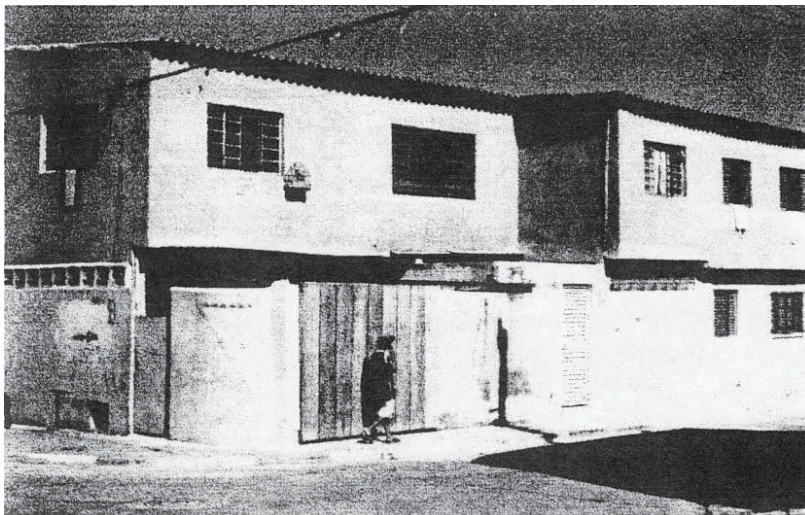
NO LUGAR DO EMBRIÃO DEMOLIDO FORAM CONSTRUÍDOS DOIS PAVIMENTOS OCUPANDO TODO O TERRENO
